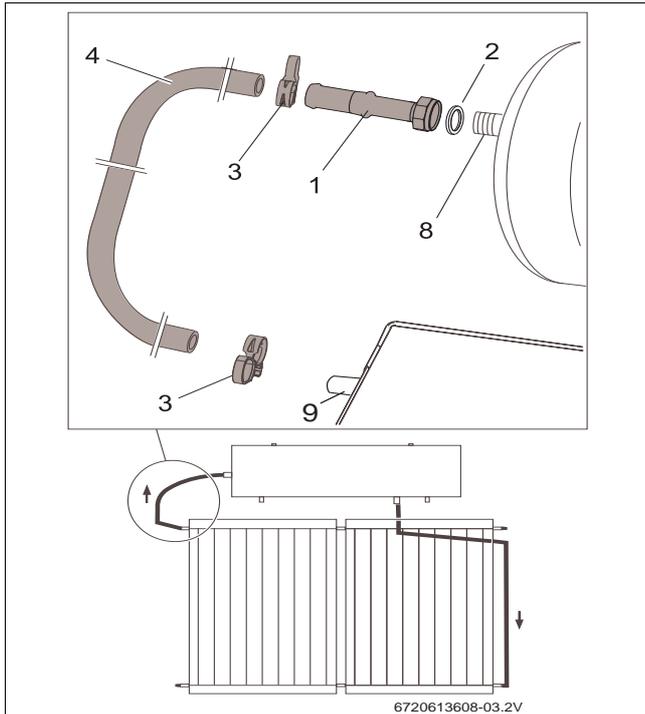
Montar a tubagem de avanço (sistema de 300l)
